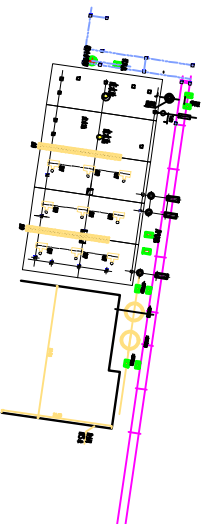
(3) 无水氯化钙反应装置区平面布置图
